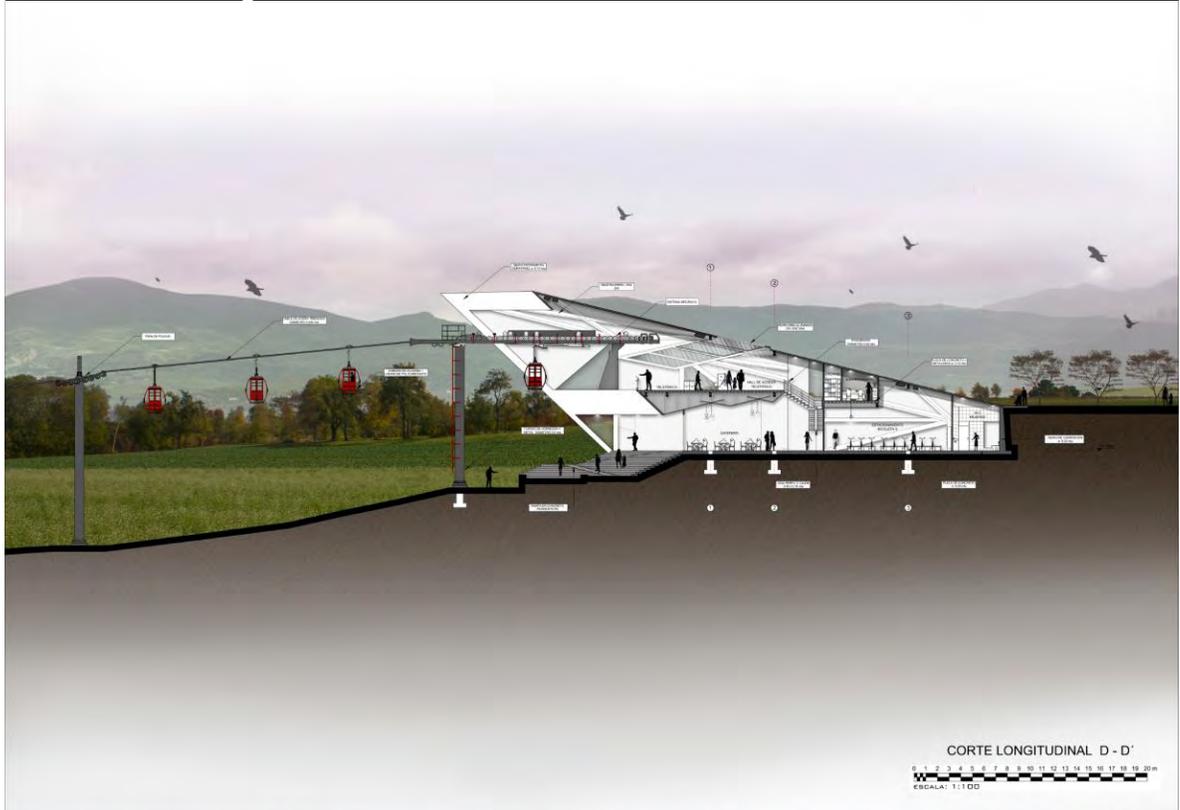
Corte Longitudinal D-D' . Fuente: Elaboración propia
